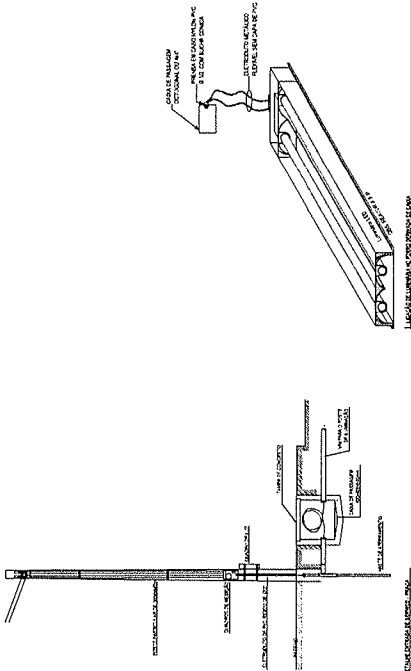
DETALLE DE LA CARRUPEL DE CONEXION DE LAS LAMPARAS
